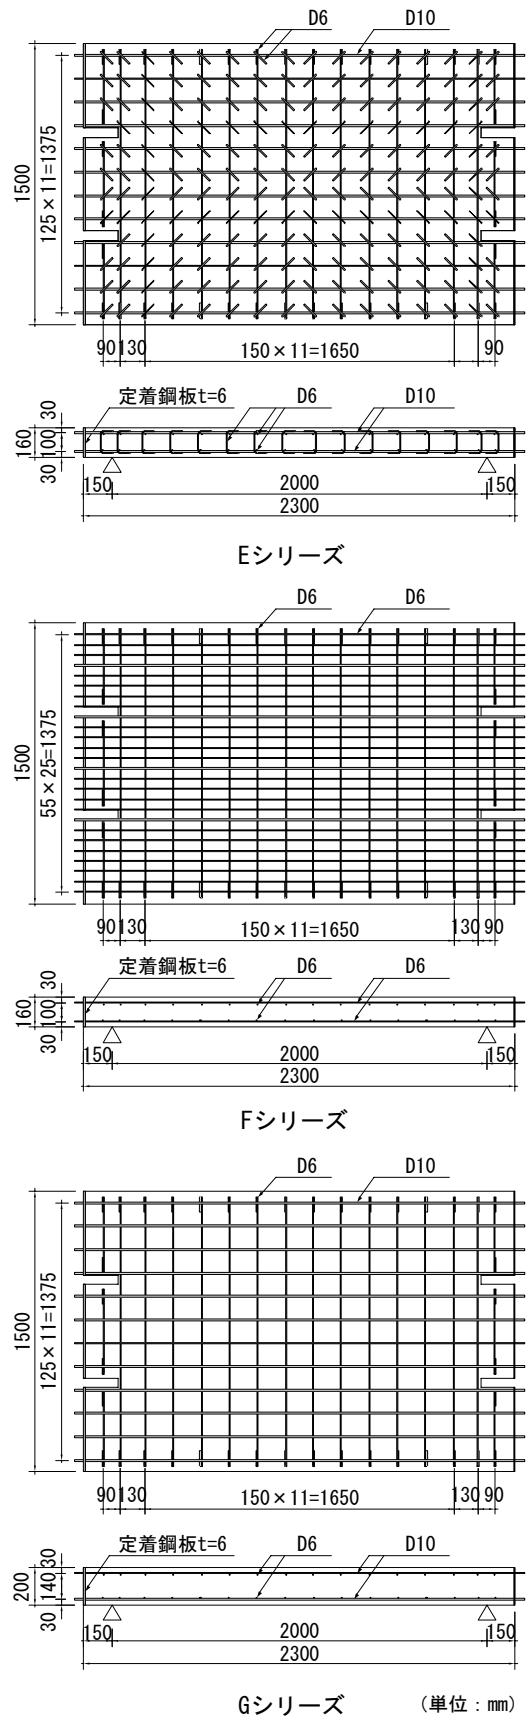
試験体の形状寸法および配筋 (E, F, Gシリーズ)
